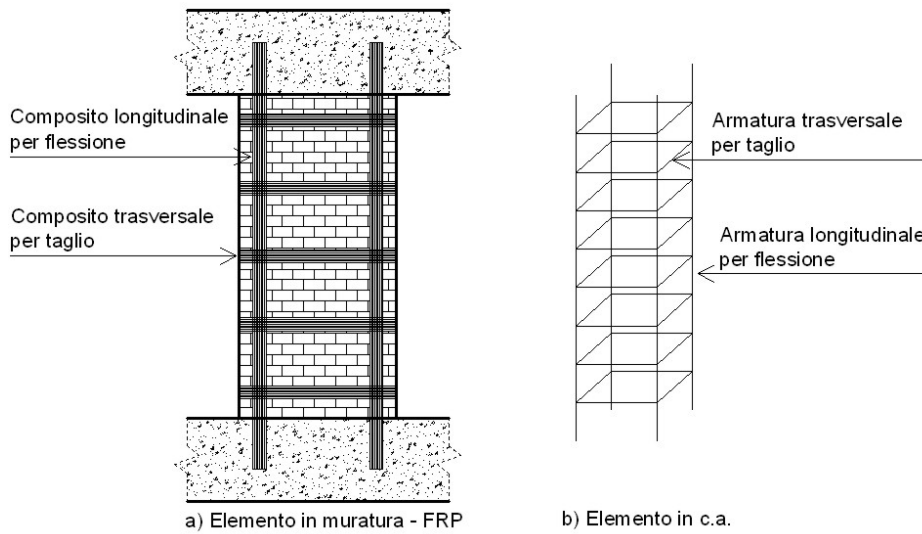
Analogia tra elemento in muratura-FRP ed elemento in calcestruzzo armato
